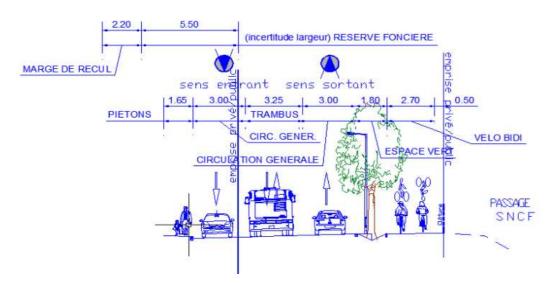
Profil en travers de la voirie (Source : Études préalables de la T1)
